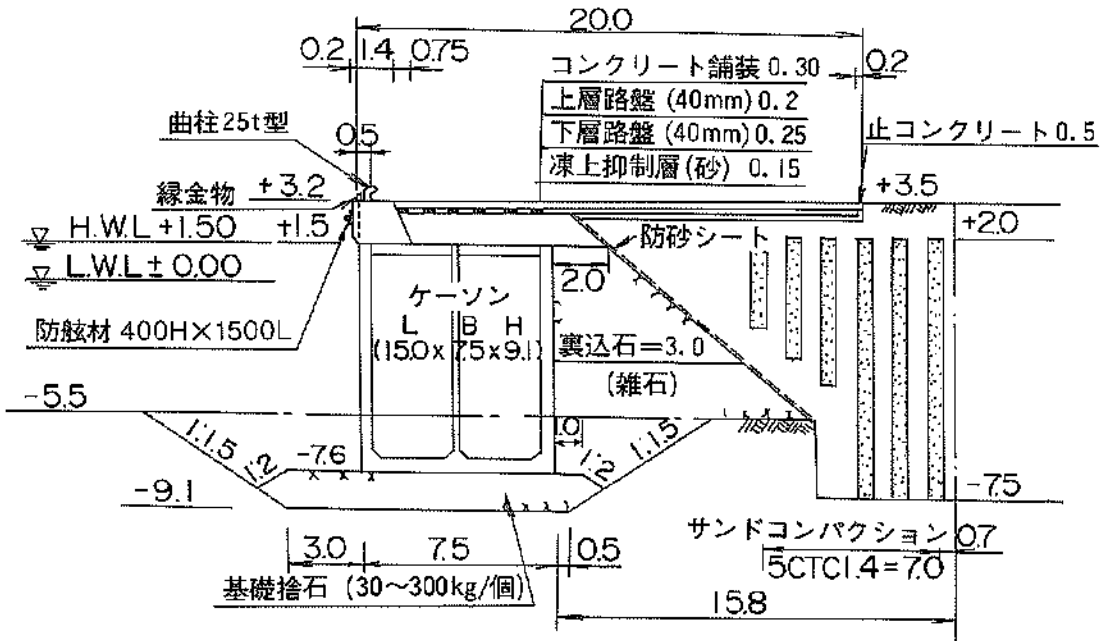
標準断面図 (十勝港, ①岸壁(南-7.5m))
